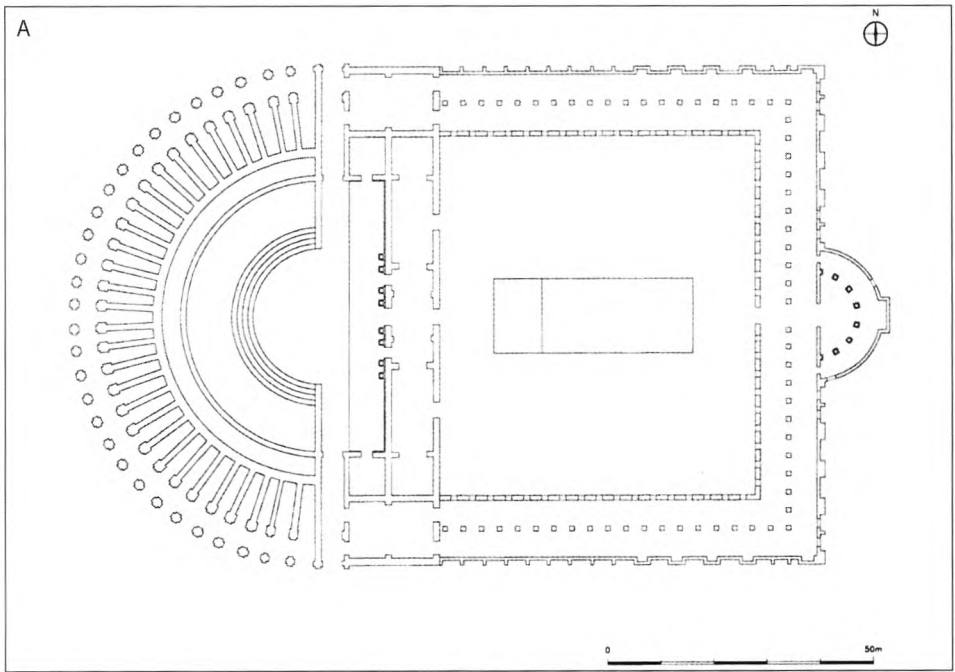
Planimetría reconstructiva del Complejo de Balbo:
